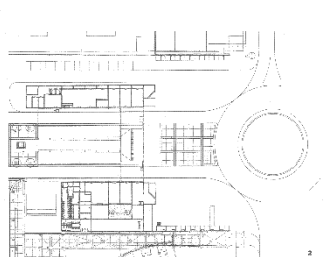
Planta térrea da Porta Norte Expo '98 | Manuel Tainha
